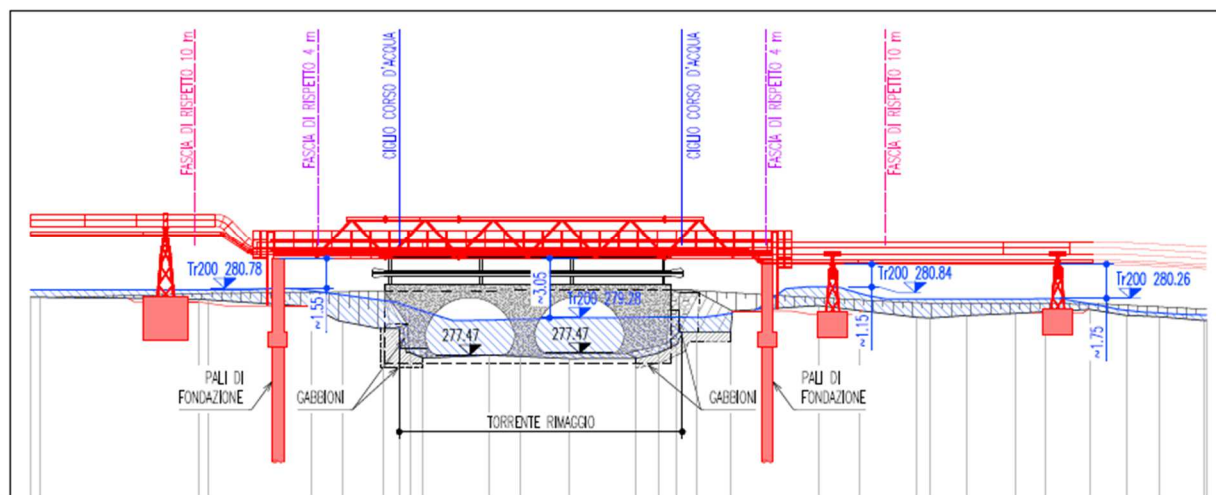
Sezione dell'attraversamento aereo tubiero del Torrente Rimaggio e Ponte sul Rimaggio. Dall'elaborato R36304\_GCVI9.
